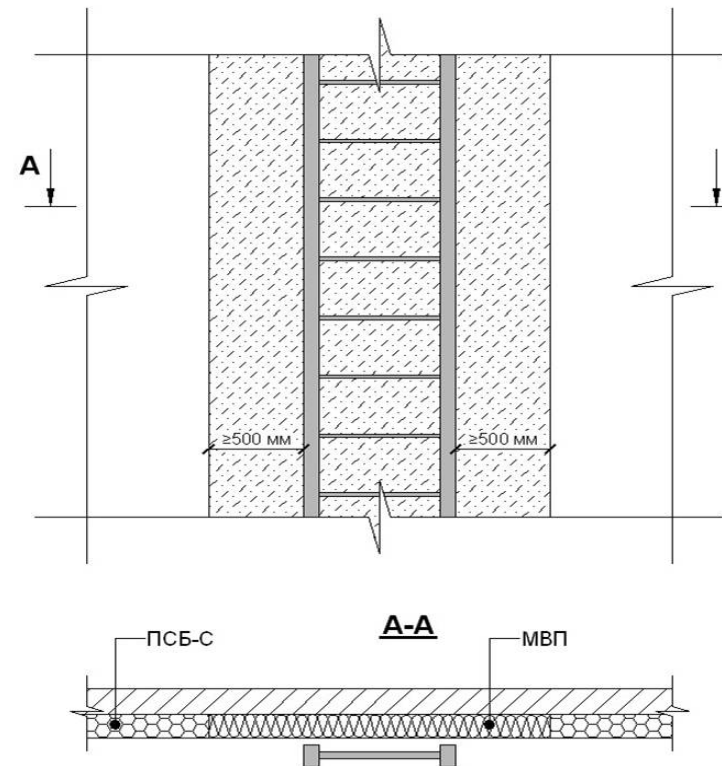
Участки примыкания СФТК к пожарной или наружной маршевой лестнице здания.
